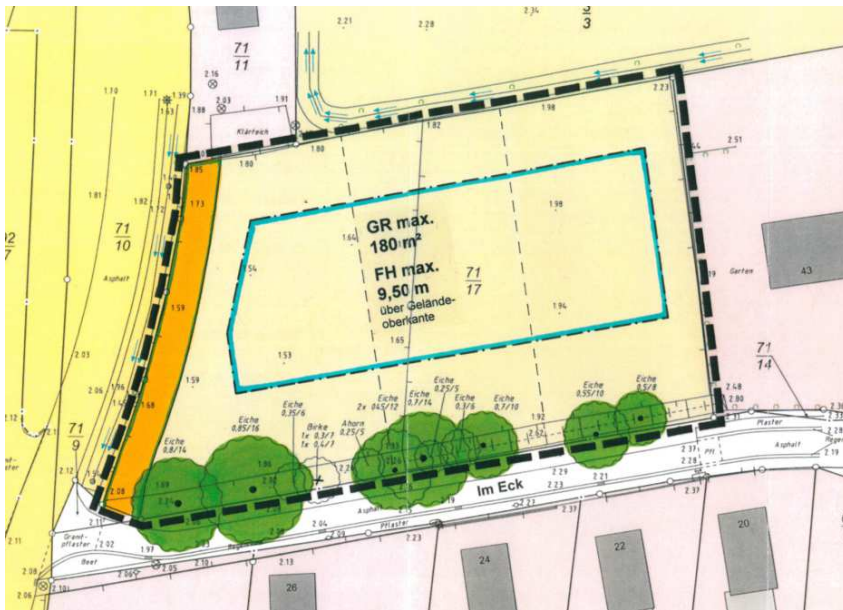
Ausschnitt der Planzeichnung der Ergänzungssatzung „Im Eck“. Gemeinde Oldenbüttel. 2012.
